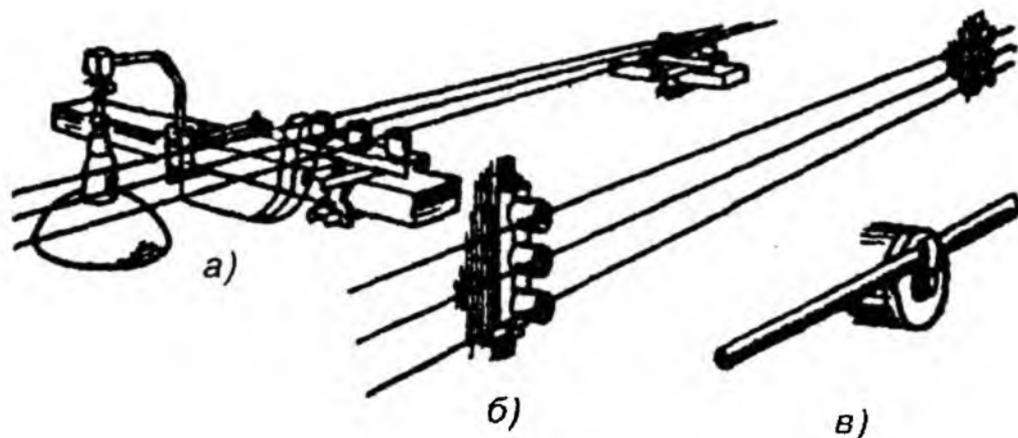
Примеры выполнения электропроводки на изоляторах:
